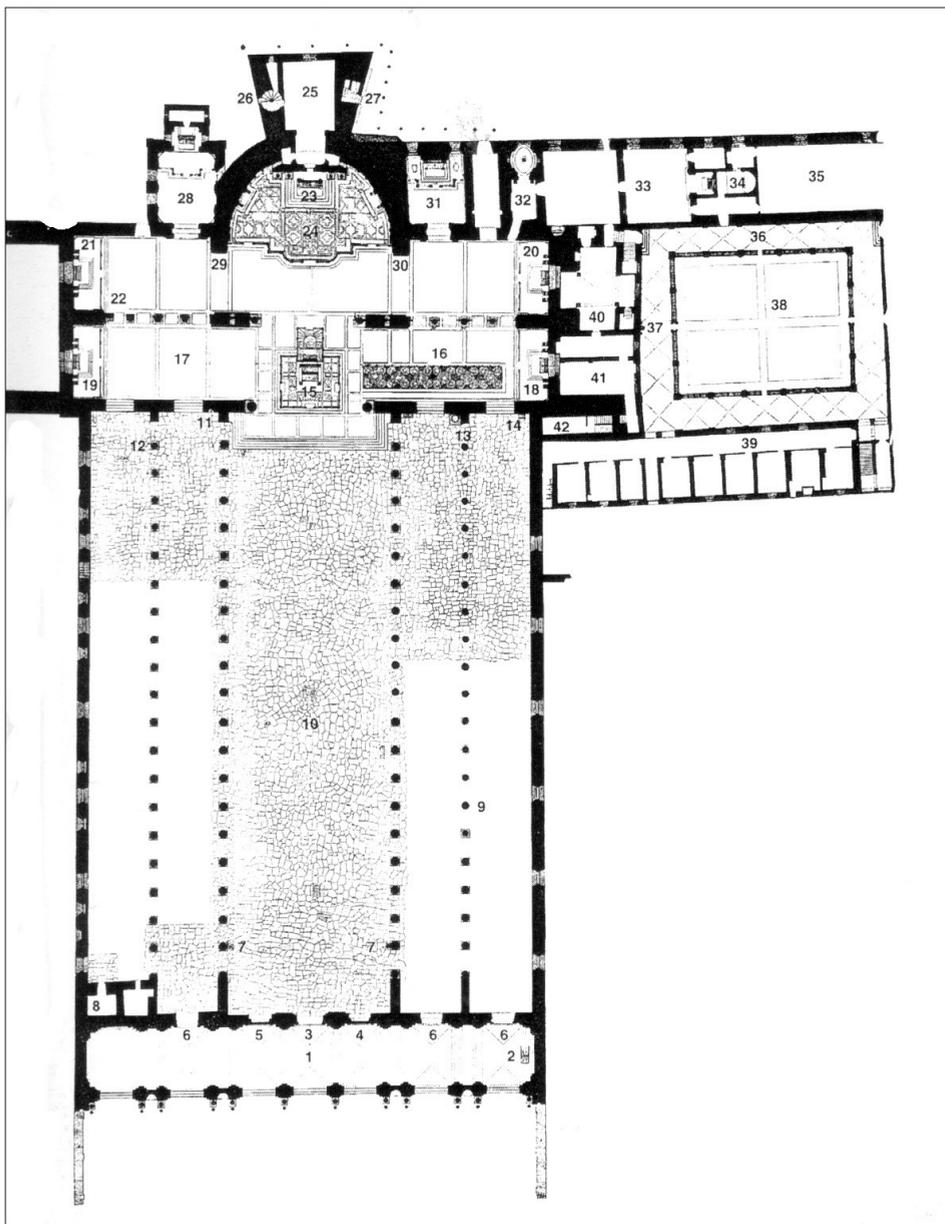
Pianta di San Paolo fuori le mura (da Brandenburg 2009).
